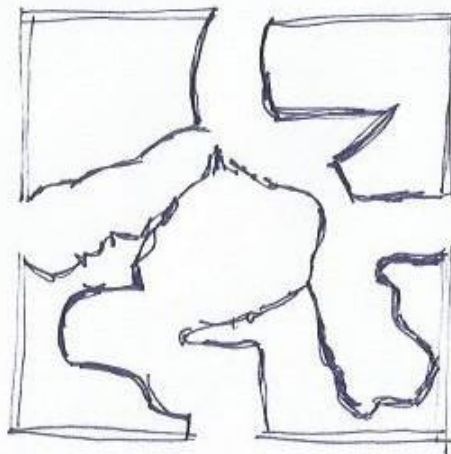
Sección Zentrum Paul Klee, Renzo Piano
